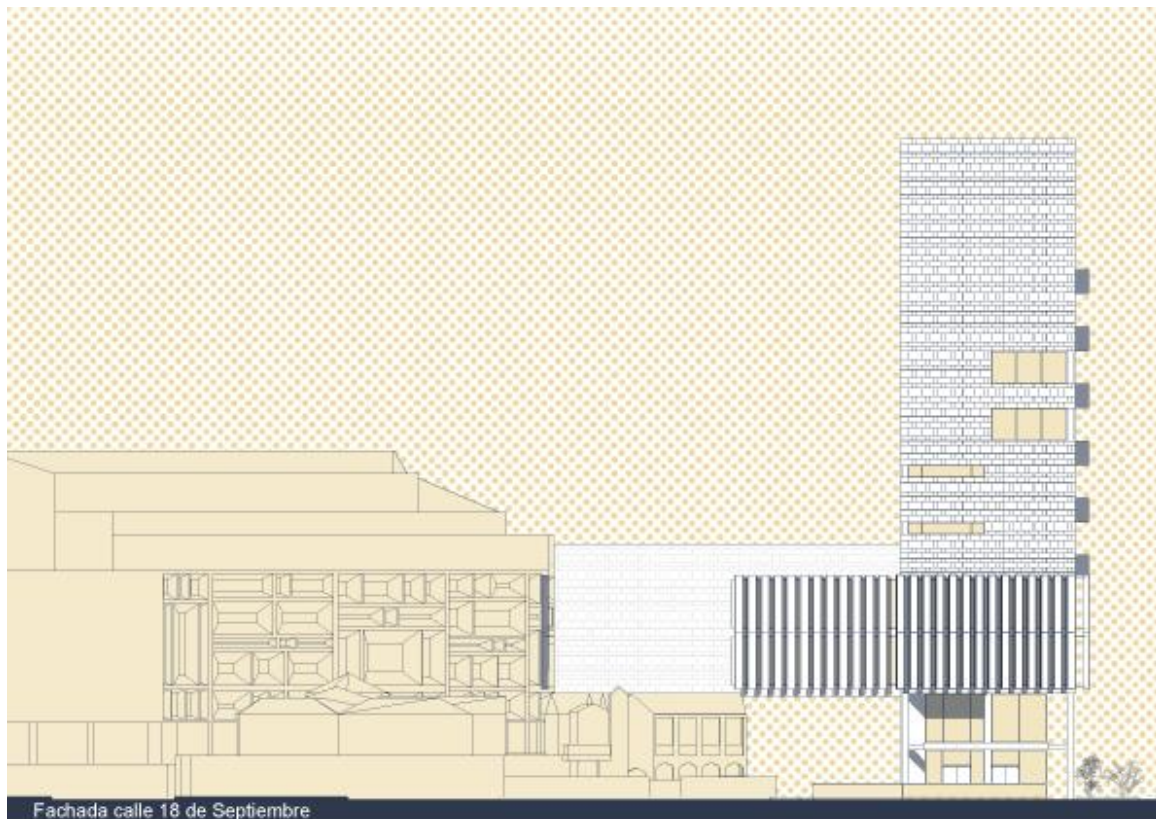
Fachada Posterior calle 18 de Septiembre. Autoría propia
